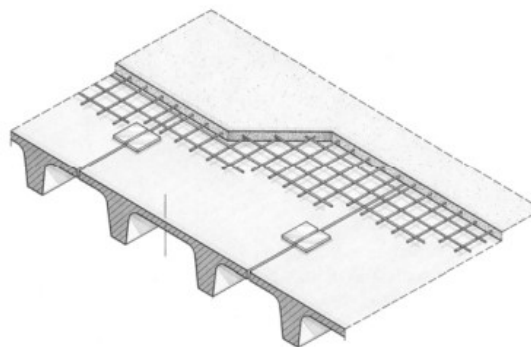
elementi prefabbricati di solaio in calcestruzzo (coppelle)
